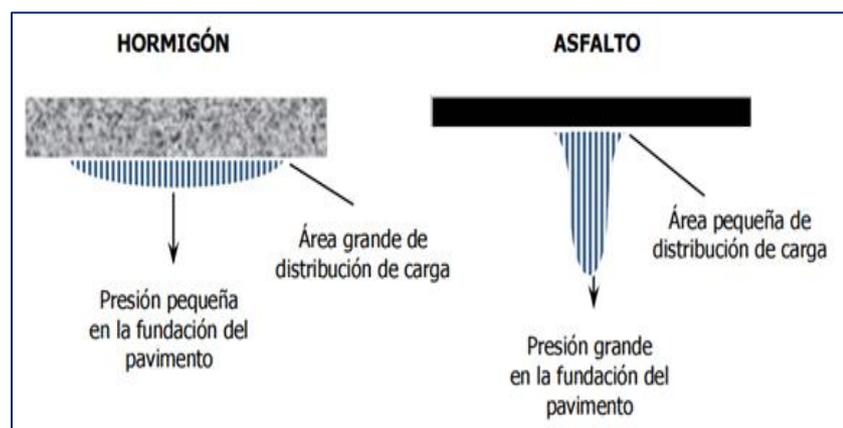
Esquema del comportamiento de pavimentos Flexibles y Rígidos
